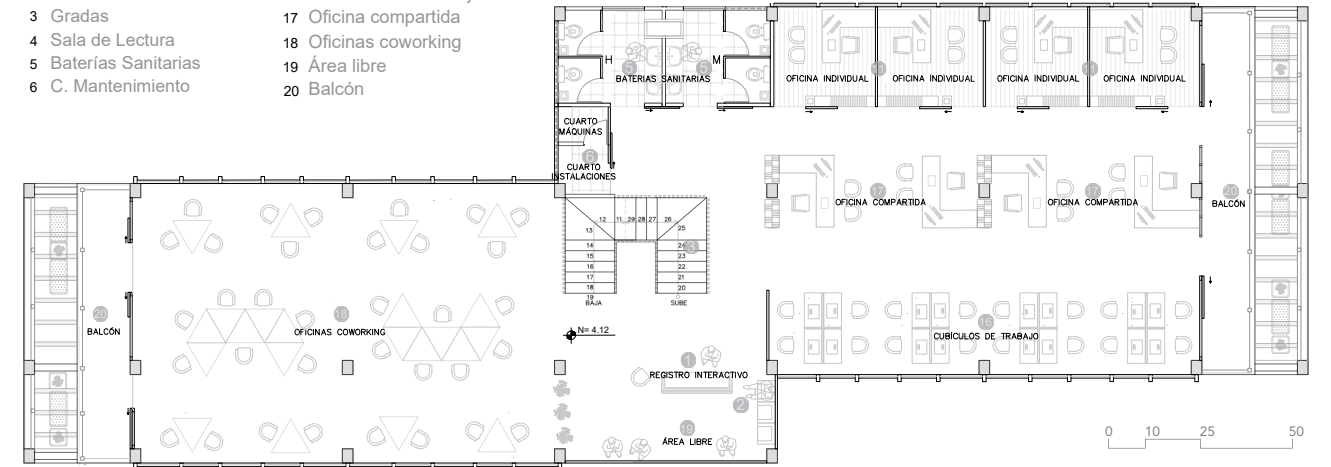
Planos Arquitectónicos, Planta baja. Elaborado por: El Autor, 2022.
